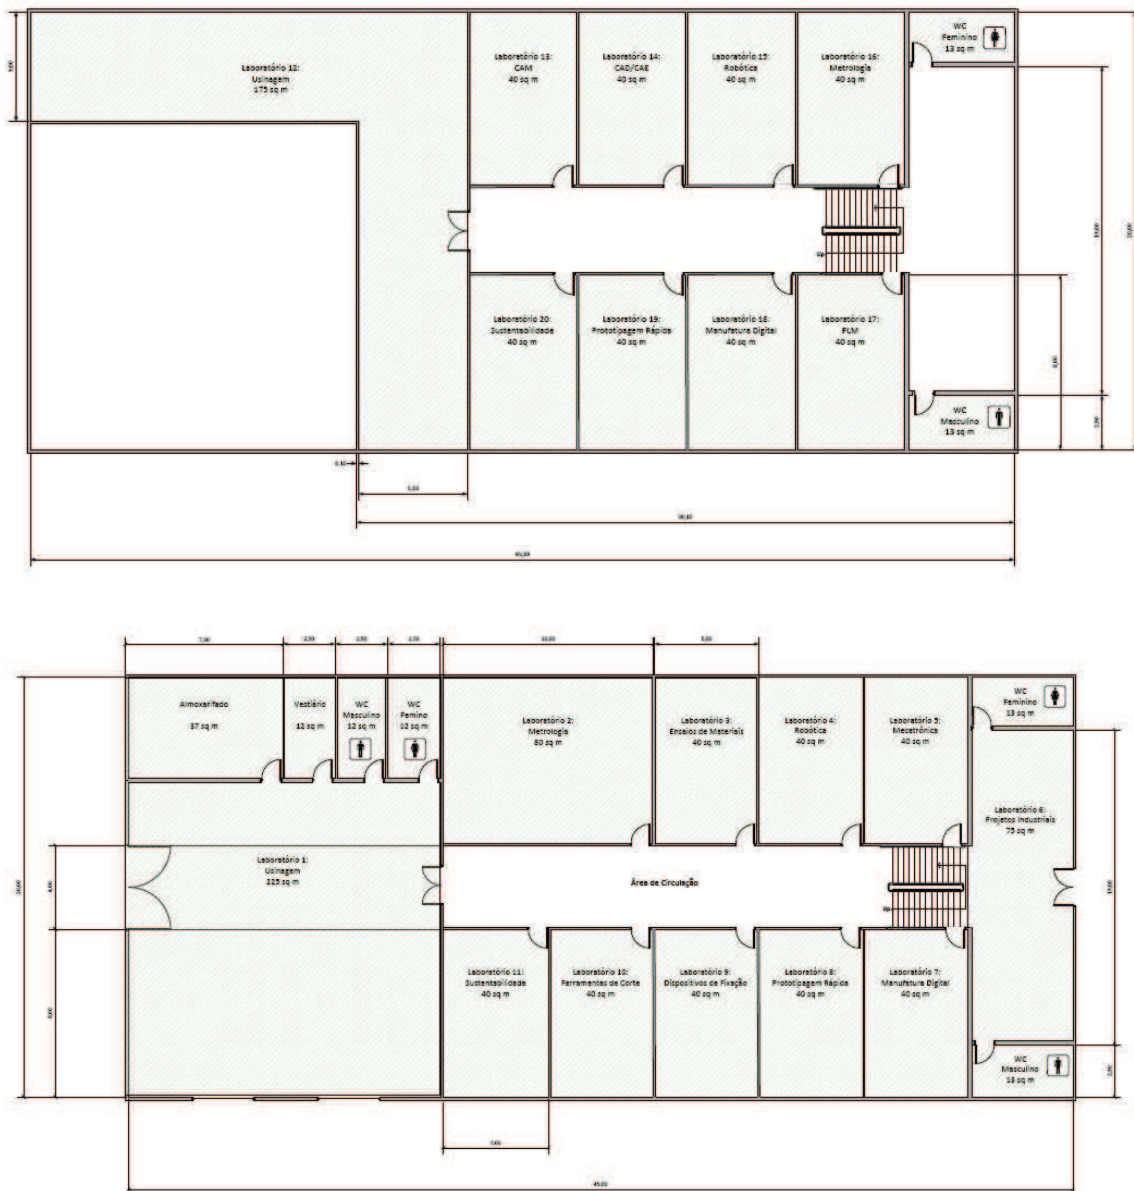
esboços de plantas baixas da extensão do CCM. Pisos superior (500 m²) e térreo (900 m²)
